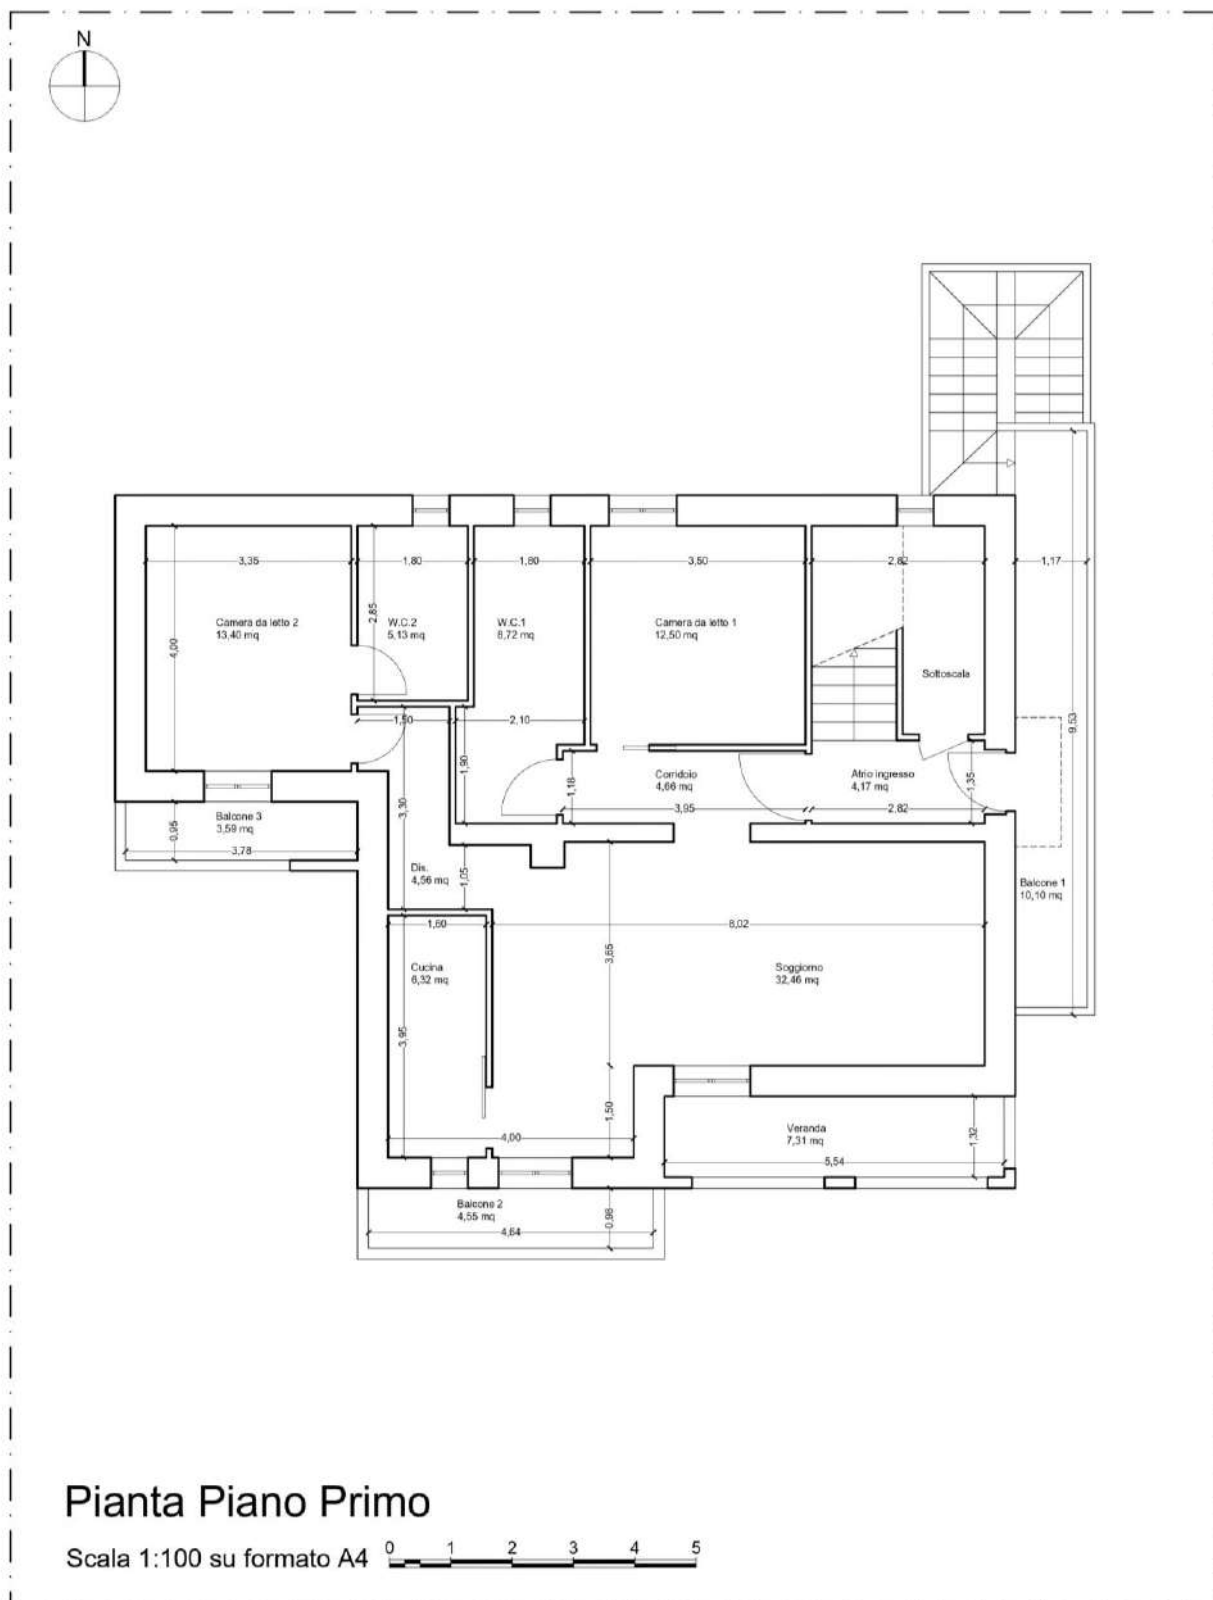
Planimetria dello stato di fatto – Pianta Piano Primo
